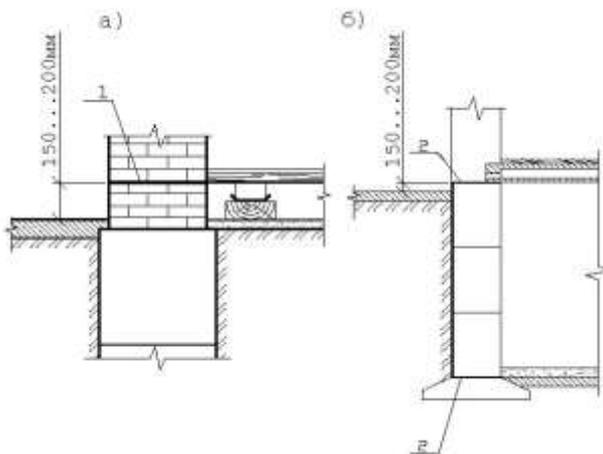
Изолация сырости стен бесподвального здания (а) и стен подвального помещения (б):
